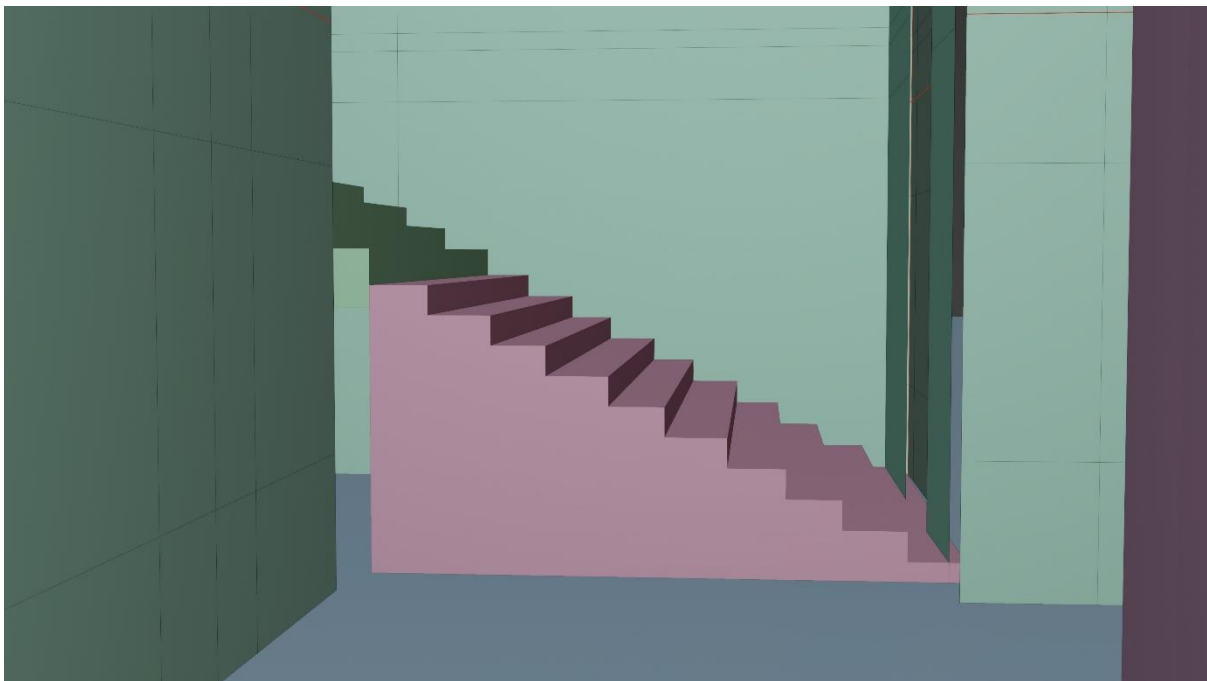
Reconstrucción de la escalera. Elaboración propia.
